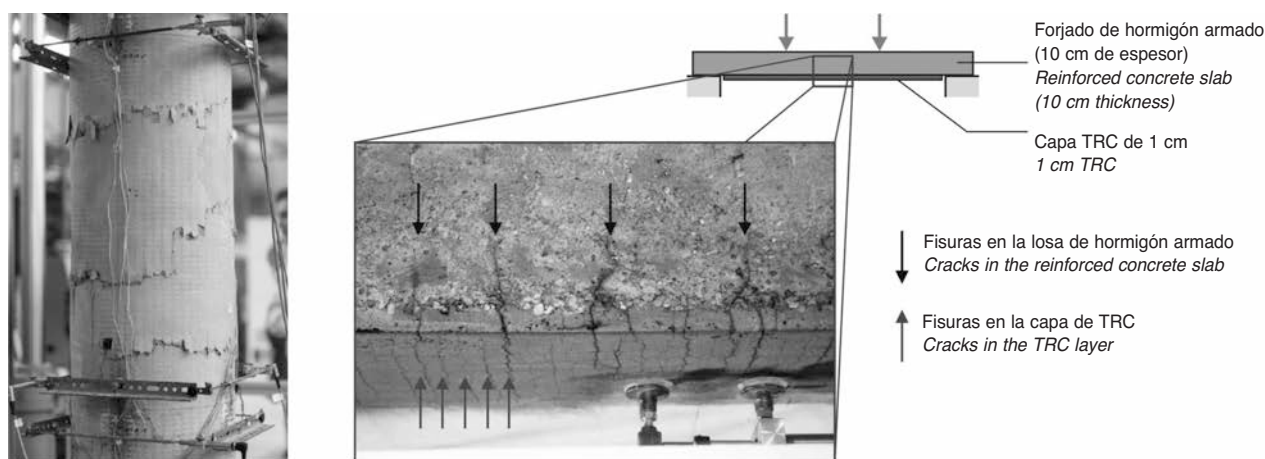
Fisuración en un pilar y un forjado reforzados con hormigón armado con textiles [5], [26], [27]
